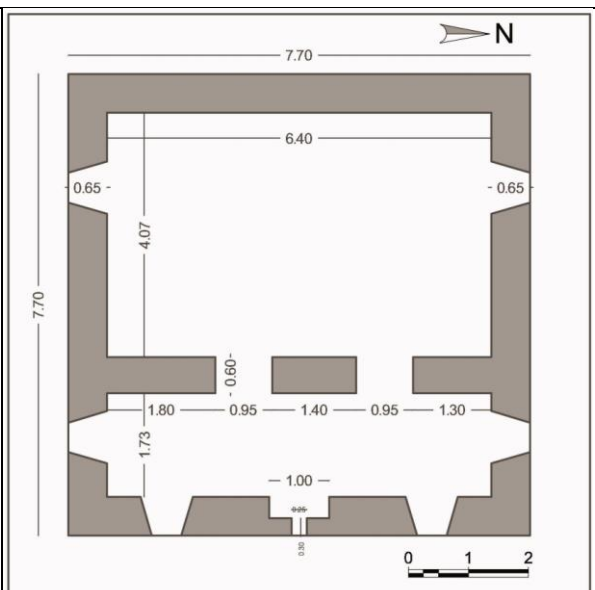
أطم (حصن) بن عميره: مسقط أفقي للطابق الأول.
